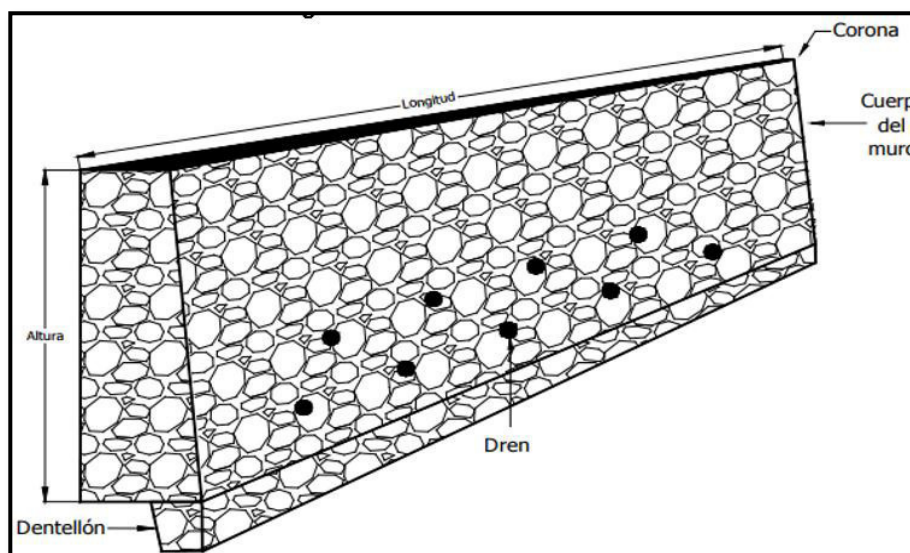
Muro de mampostería de piedra Braza y dentón, para riegos de deslizamiento
